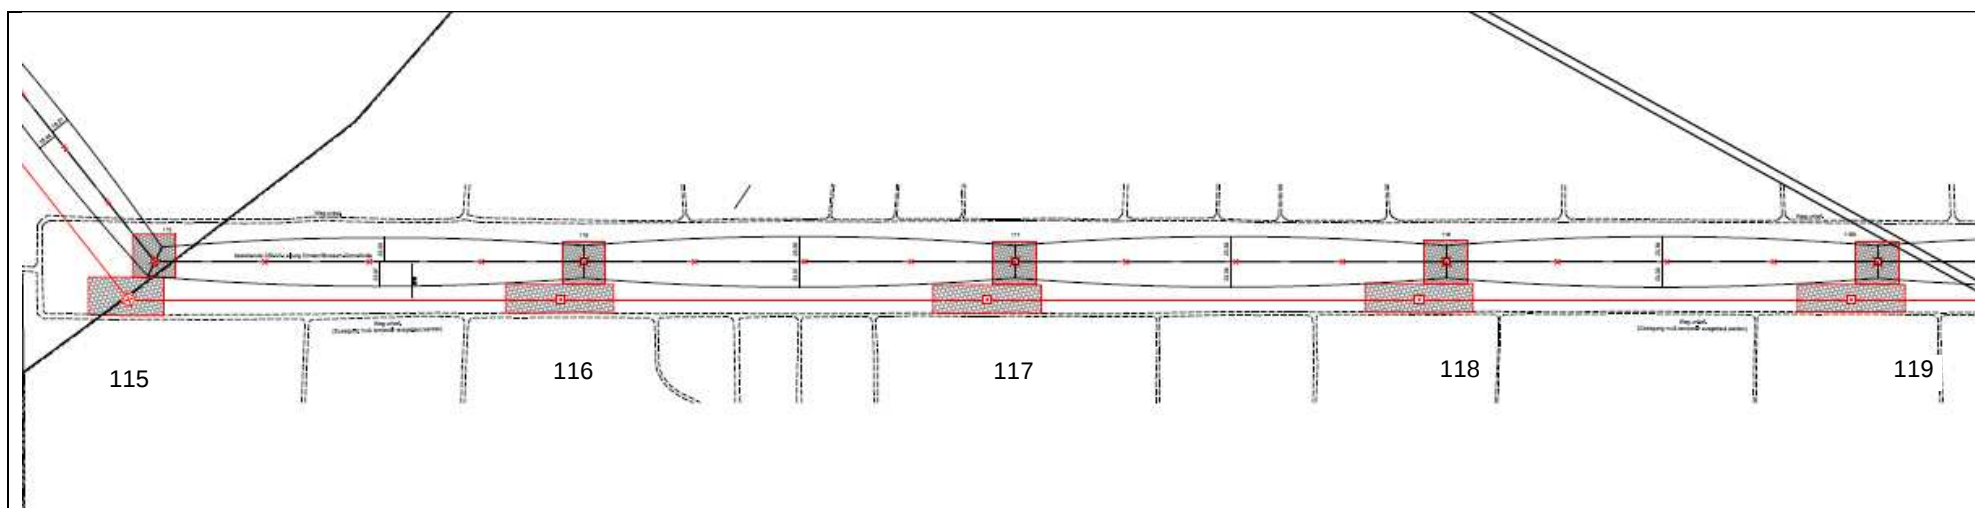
Beispielhafte Planung für den Bau der 380-kV-Leitung parallel zur bestehenden 220-kV-Leitung im Bereich Stapeler Moor
